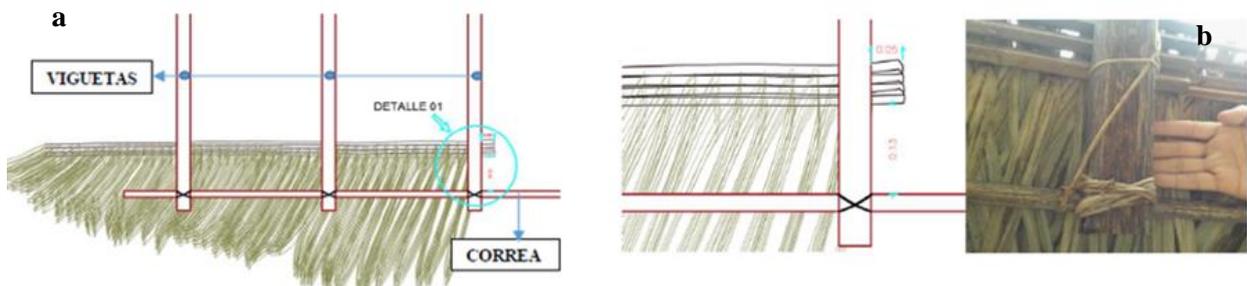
Colocación de primer paquete (a); 5 cm de traslape en vigueta y separación 13 cm de primera correa (b)
